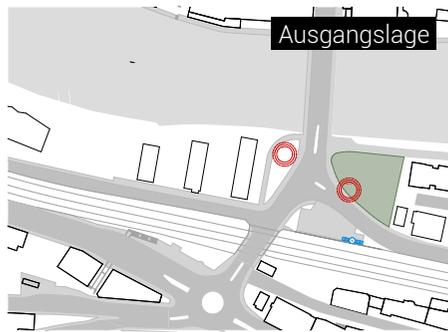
Prüfung Eichenerhalt bei einer südliche Bebauung des Dammgärtlis
